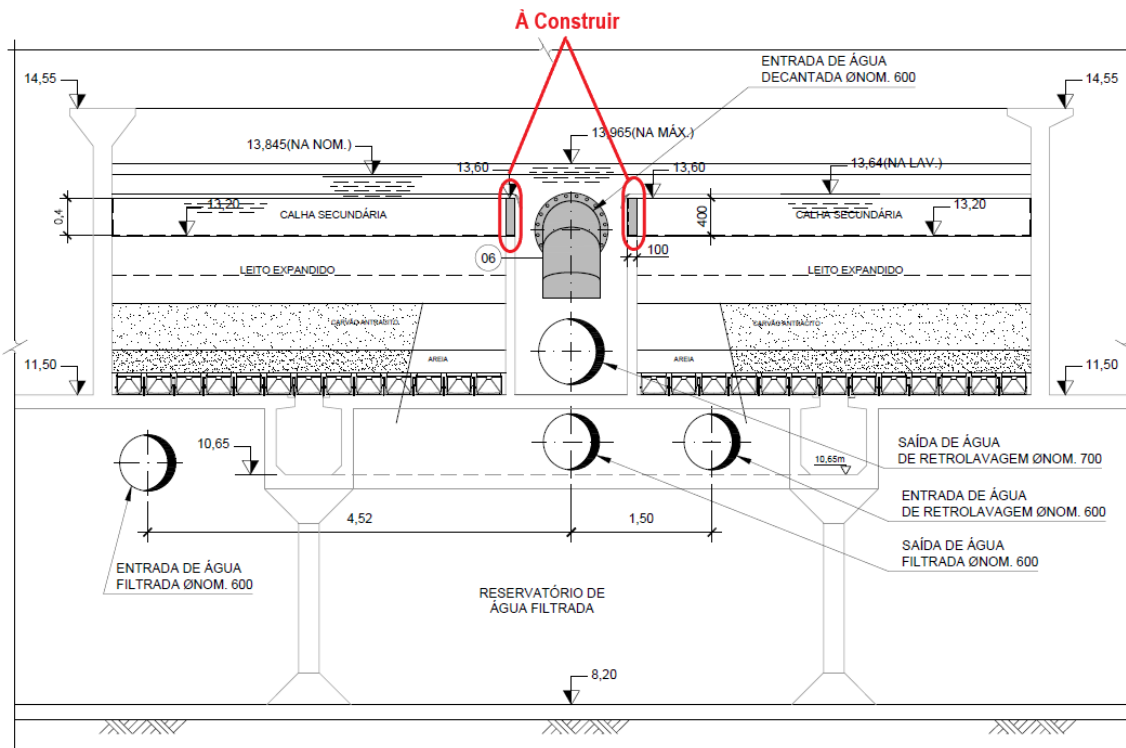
Corte transversal do filtro com a indicação da complementação em concreto armado da parede da calha de lavagem.
